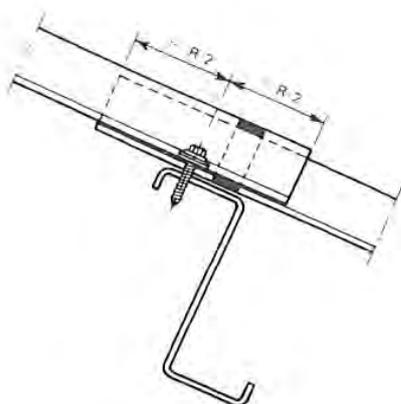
Complément d'étanchéité — Pose avec fixations en plage
